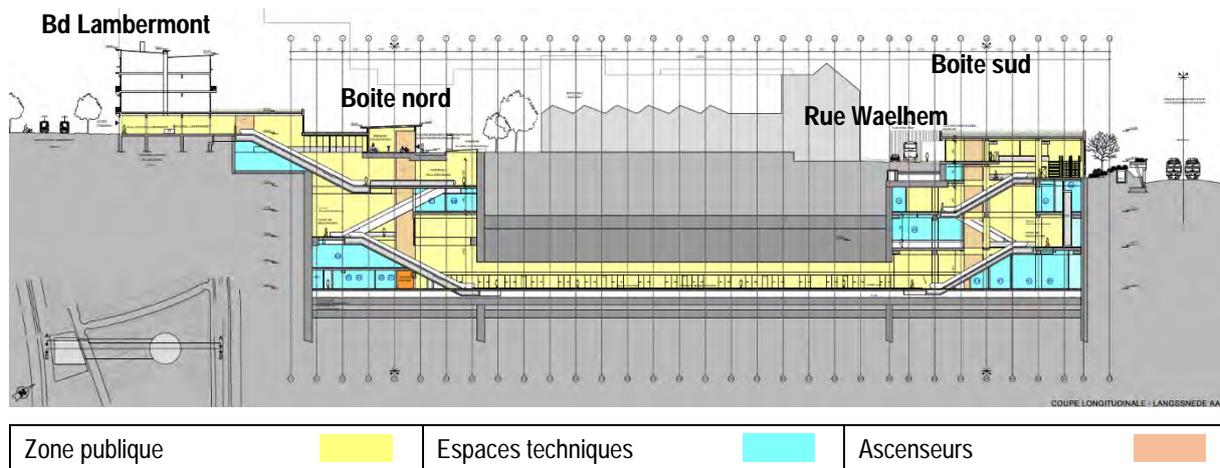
Station Verboekhoven, coupe longitudinale (BMN, 2018)
